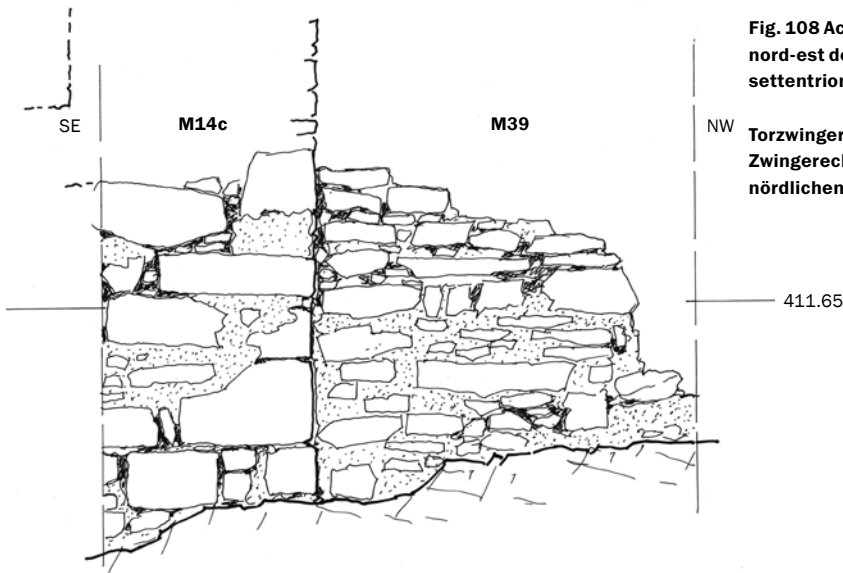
Accesso fortificato X, area A 24. Facciata esterna dell'angolo nord-est dell'accesso fortificato M14c, con muro di cinta M39 dell'atrio settentrionale.
